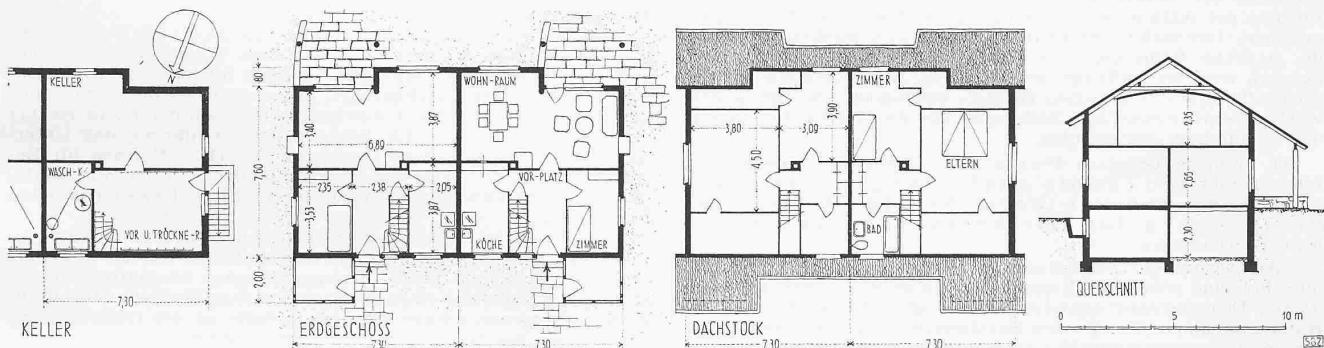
bis 13. Siedlung «Im Wiesental», Kilchberg. Arch. ALFRED BINGGELI, Zürich-Kilchberg. — Grundrisse und Schnitt 1:300, Haustyp B
